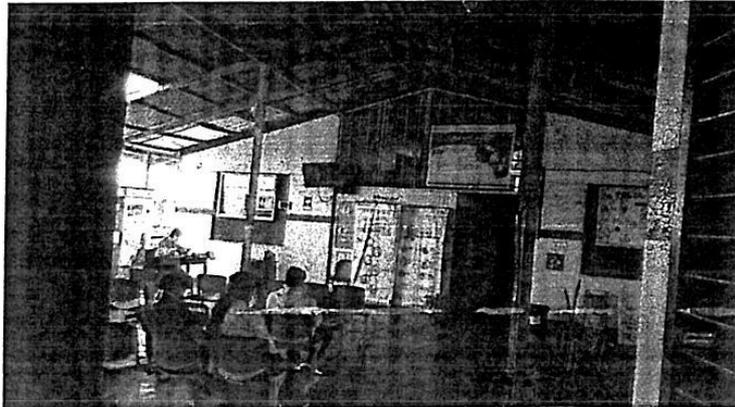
,5: Vista de la estructura de madera y calamina deterioradas
